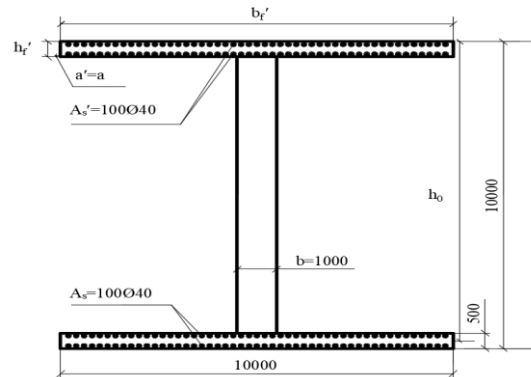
Схема армирования расчетного поперечного сечения сооружения.
